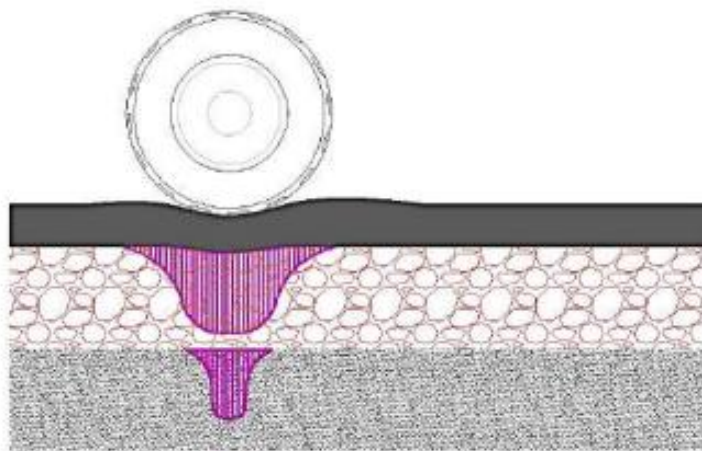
Deformaciones de una estructura de pavimento flexible.
